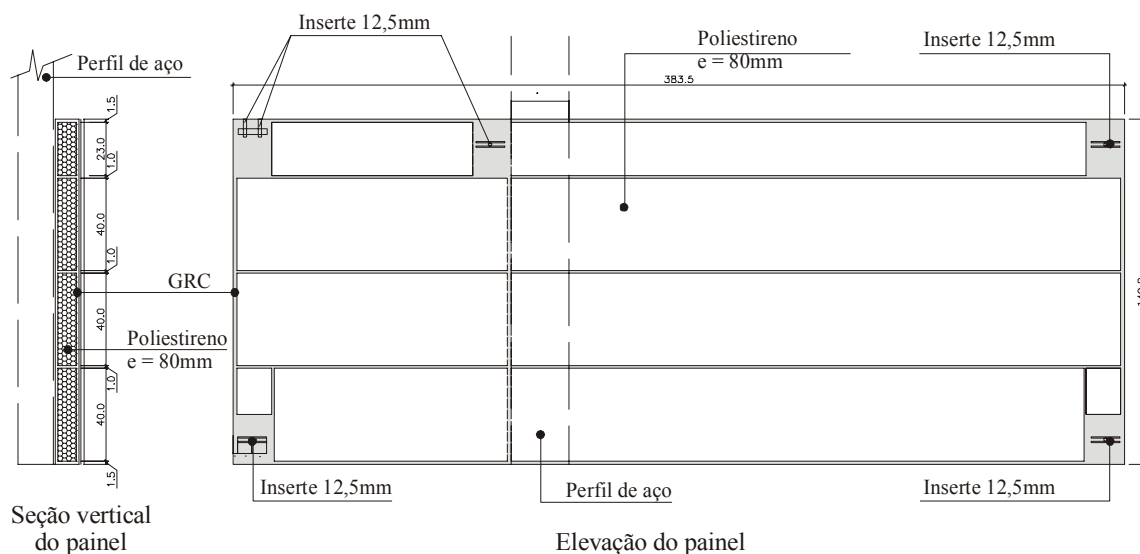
Detalhamento do painel tipo sanduíche A7
